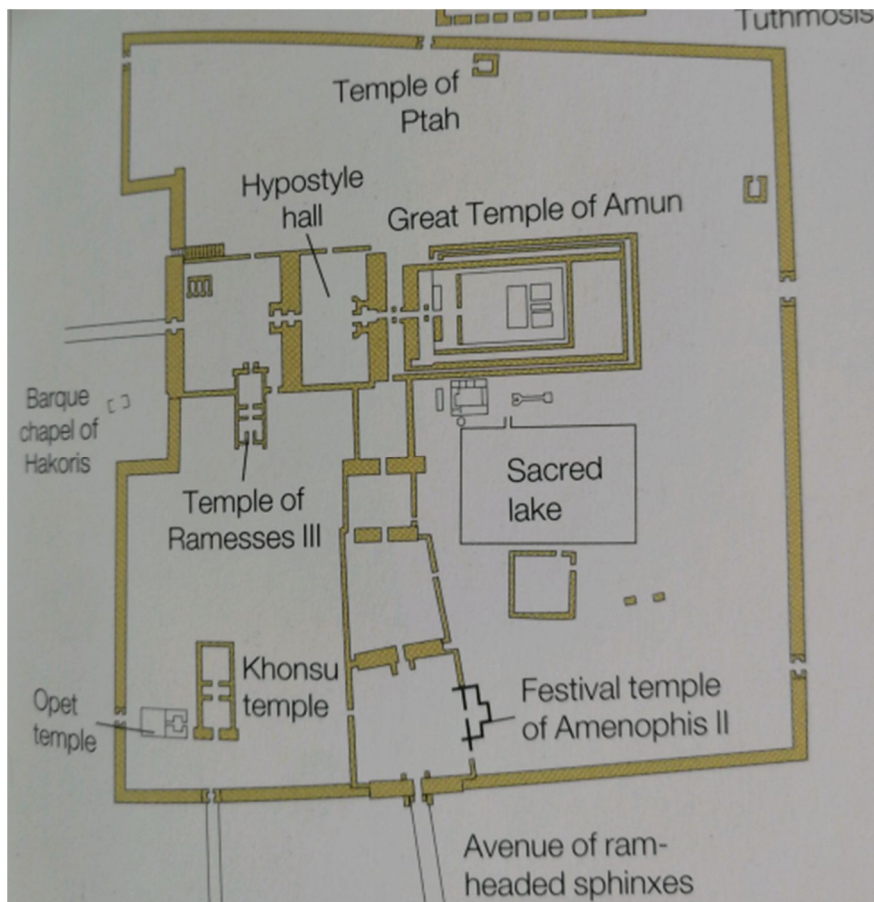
Plan du sanctuaire d'Amon. Egypte, Haute-Égypte, Thèbes
